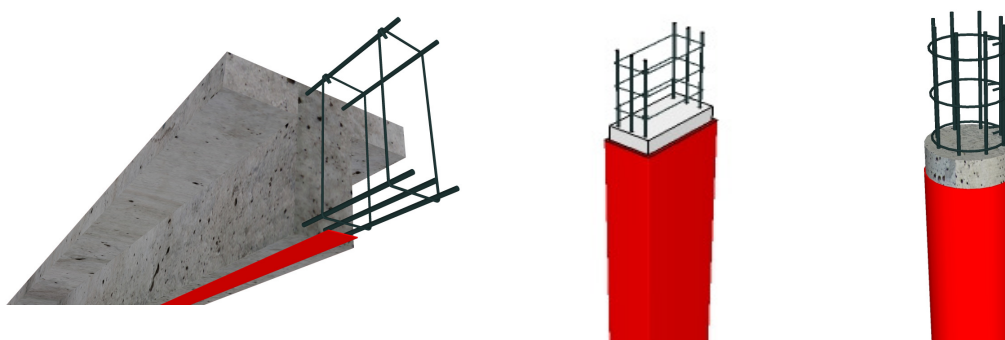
Pormenores do reforço de vigas e pilares com compósitos de FRP
